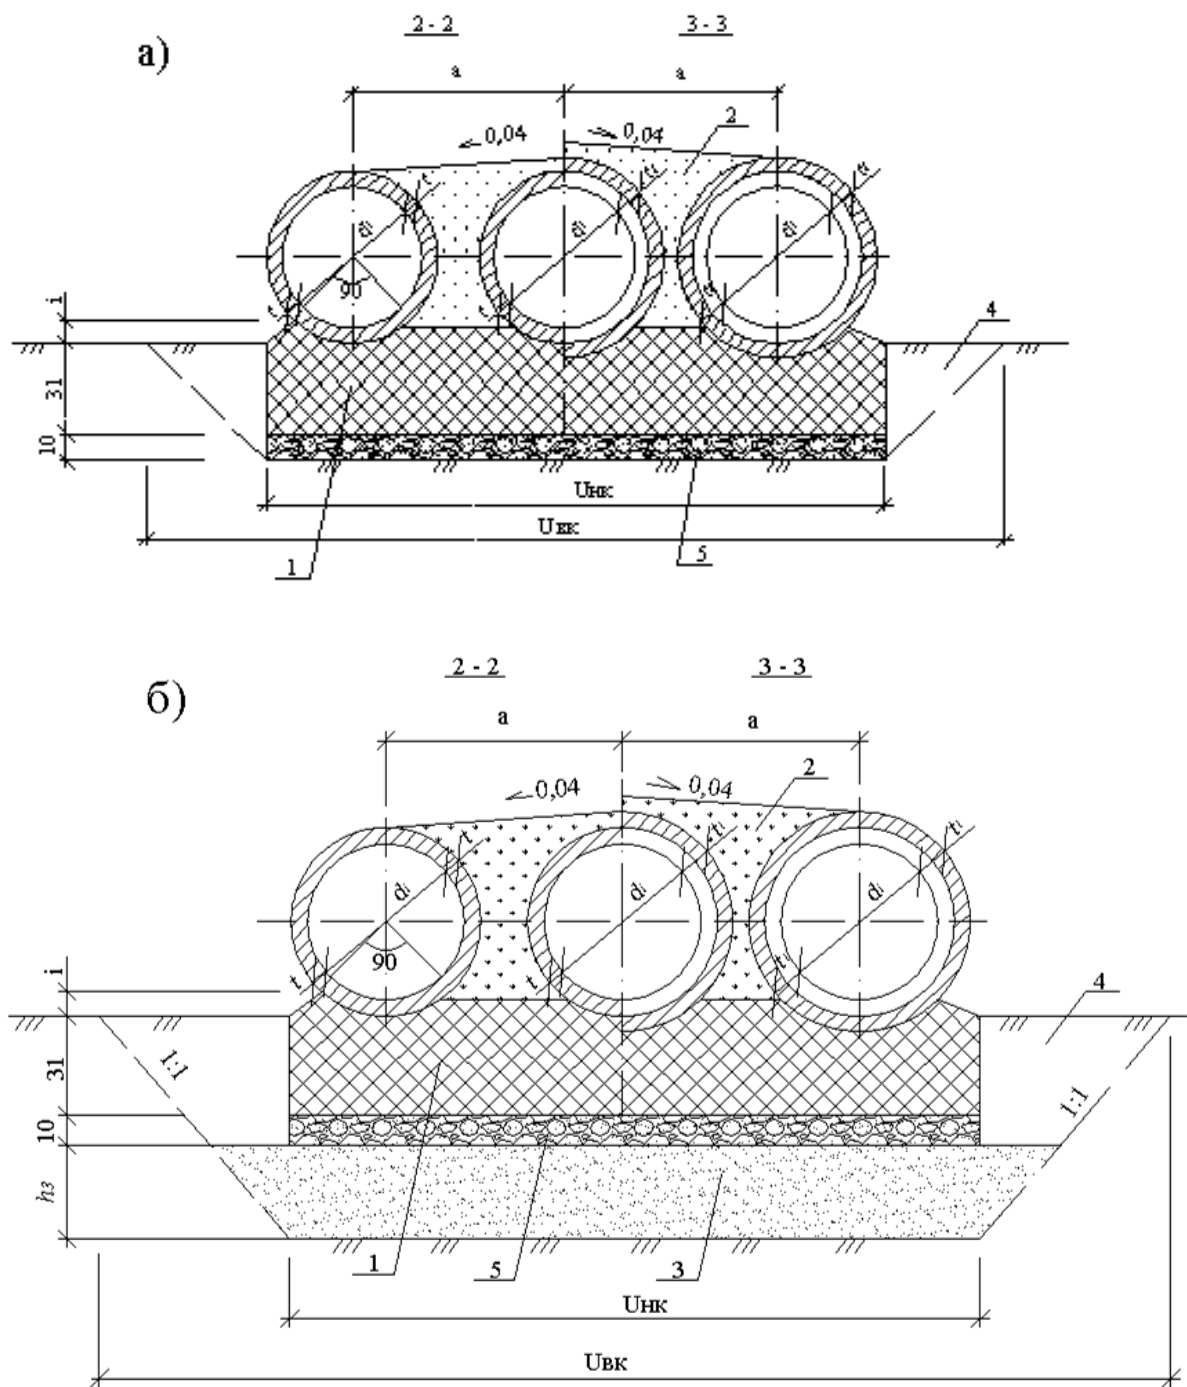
Поперечные разрезы 2 – 2 и 3 – 3 (см. рис. 2.6.2) трехочковых труб на монолитном фундаменте без замены грунта основания (а) или с заменой (б): 1 – бетон В25; 2 – засыпка пазух бетоном В7,5; 3 – замена грунта основания; 4 – обратная засыпка котлована; 5 – щебень толщиной 10 см
